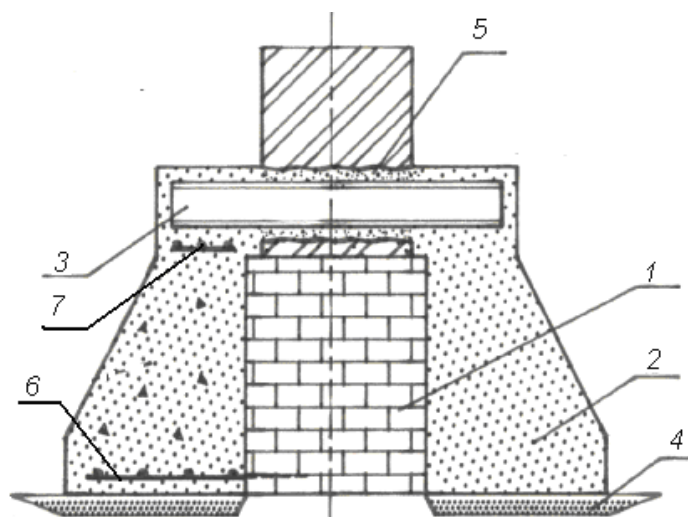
Двухстороннее уширение с поперечными балками: 1 – существующий фундамент; 2 – наращивание, 3 – стальная балка; 4 – подготовка; 5 – мелкозернистый бетон, 6 – поперечная арматура, заанкеренная в теле фундамента, 7 – продольная арматура
